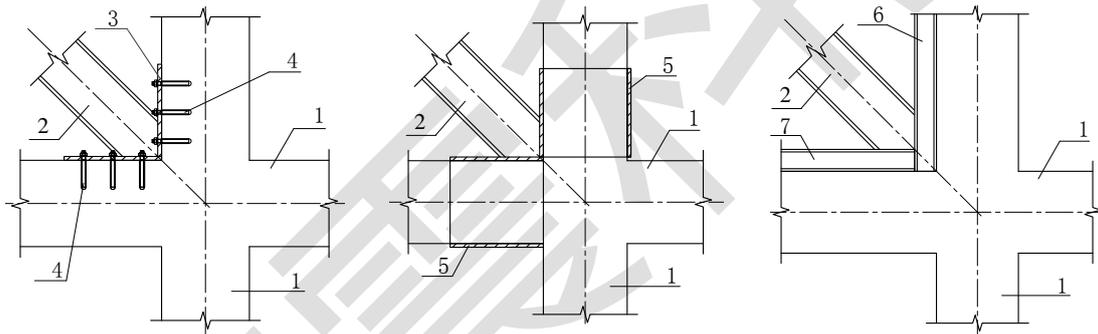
钢支撑与现浇混凝土框架节点域连接构造
